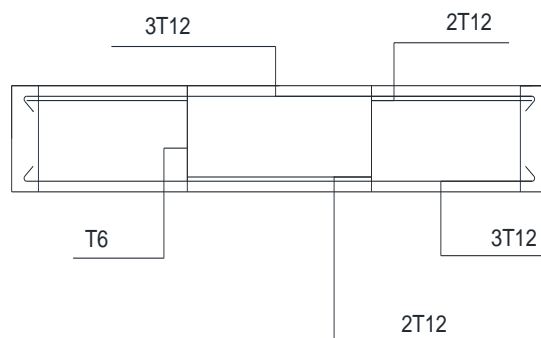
Coupe longitudinale d'une poutre secondaire 20x30cm (plan régulier)
